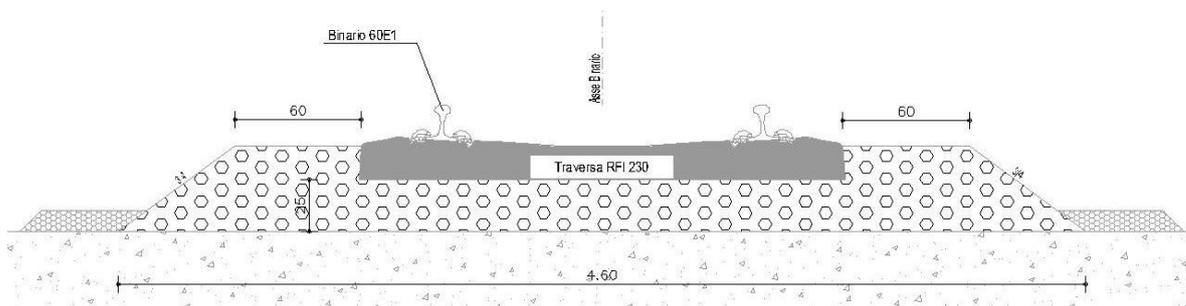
Sezione tipo armamento con rotaia 60E1 e traversa RFI 230 in c.a.p.-
